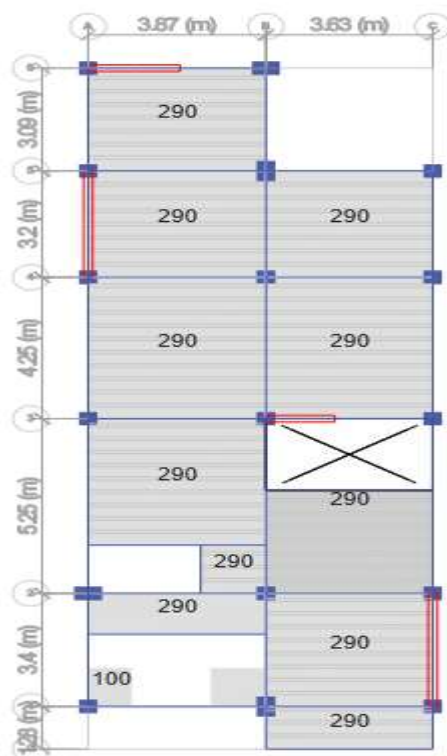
Vista en Planta Carga S dead (carga muerta asignada al 4to piso)
